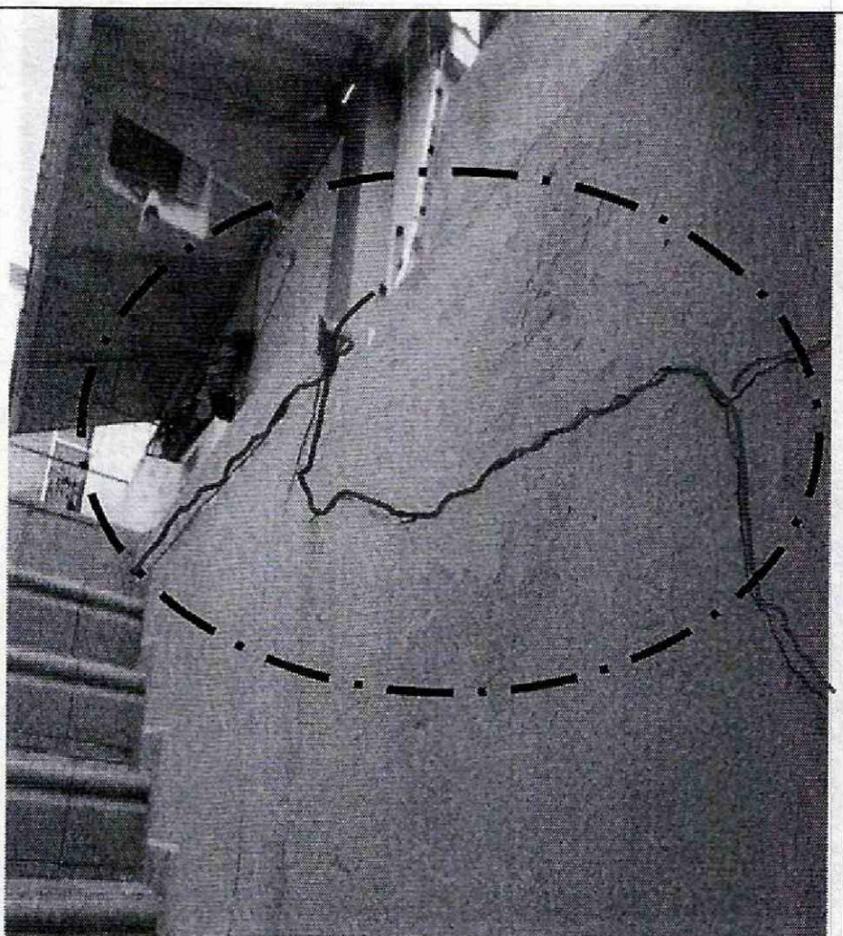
Fisuras identificadas en muros de cerramiento y divisorios en la viviendas de la Carrera 98 B No 136 - 64
